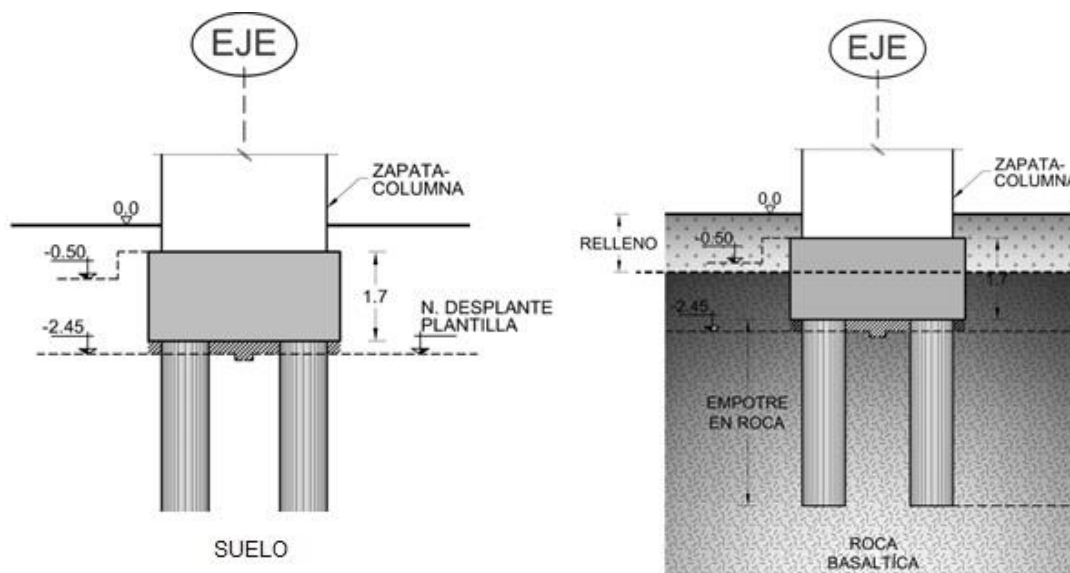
Croquis de excavación en suelo y en roca AUN y AUS
